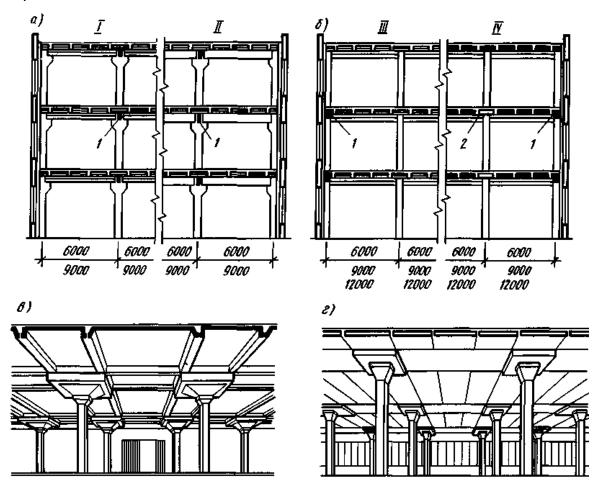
Каркасы многоэтажных промышленных зданий: а — балочный, при опирании ригелей на консоли колонн (I — вариант перекрытий с опиранием ребристых плит на полки ригелей, II — то же, с опиранием плит по верху ригелей), б — балочный, при бесконсольном опирании ригелей (III — перекрытия с ребристыми плитами, IV — то же, с многопустотными), в — безбалочный с надколонными плитами,
